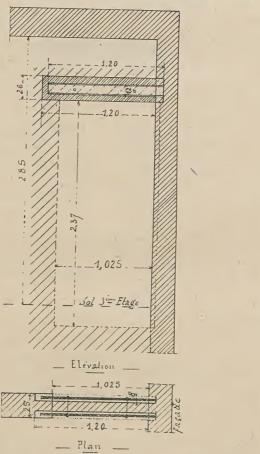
Elévation et plan sur le percement de porte entre chambre et salle de bains. — Plan et coupe sur le filet indiquant les entailles de brique.
